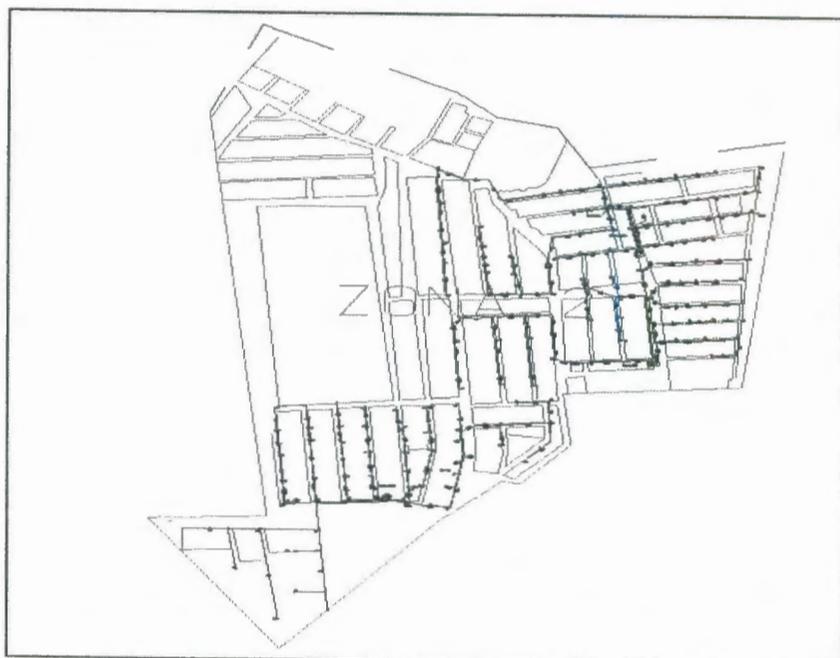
Planimetría zona 2 del sector de la vía a Daule
